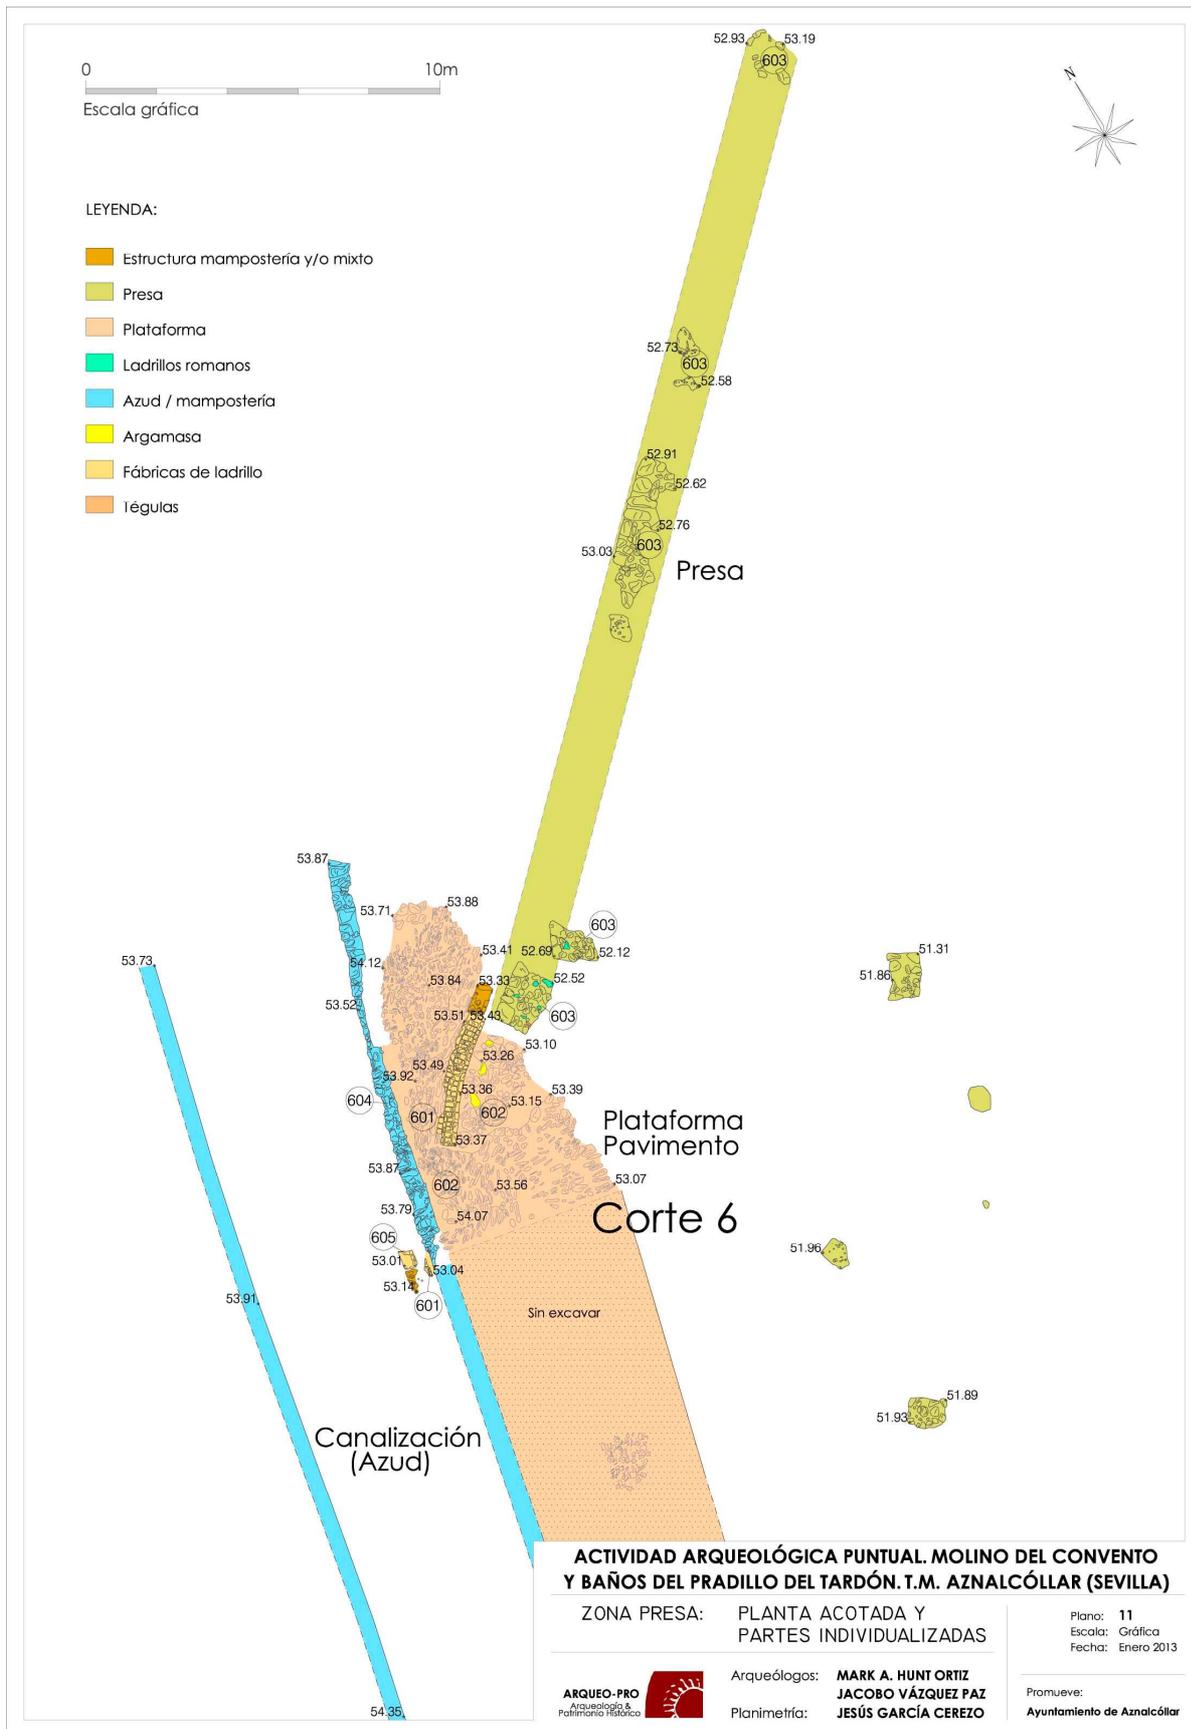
Zona presa. Planta acotada y unidades estratigráficas
